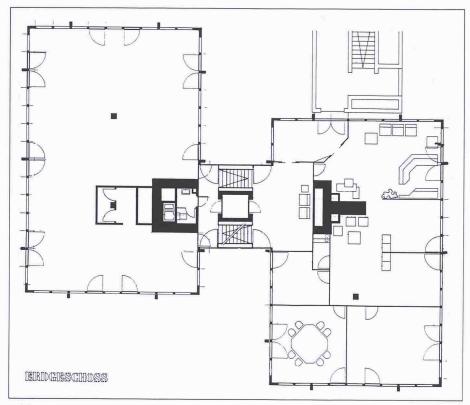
Grundriss des Erdgeschosses mit Westturm (links), Treppenhaus (Mitte) und Ostturm (rechts)
